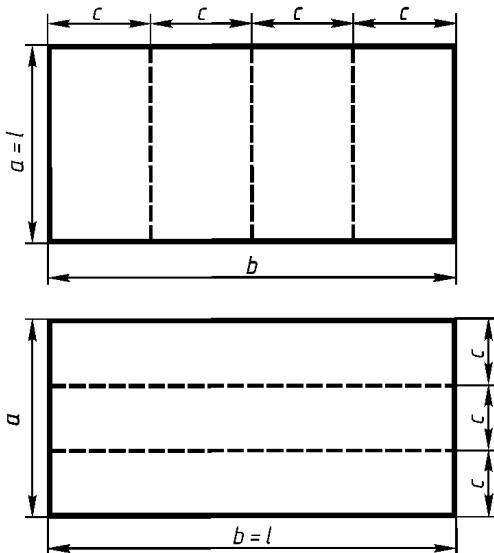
Схема расположения пластин наружной обшивки
